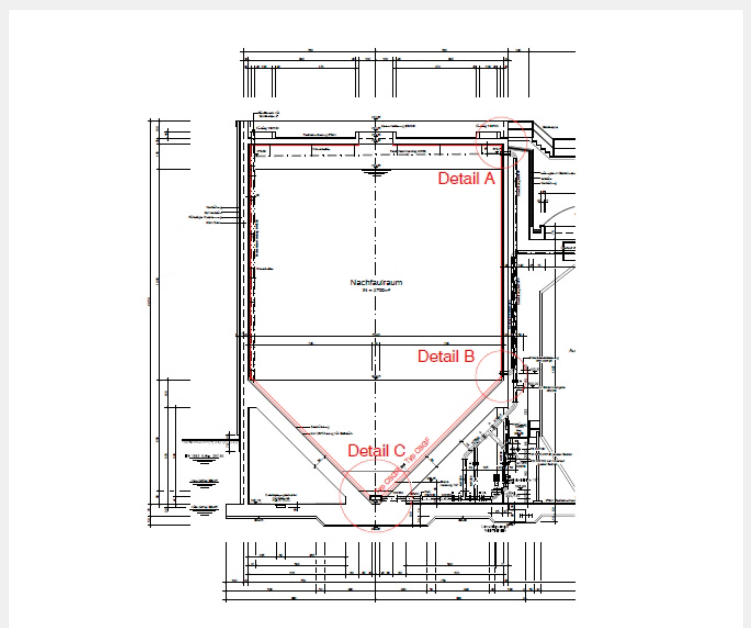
Schnitt durch den Nachfaulraum / Coupe du digesteur secondaire
